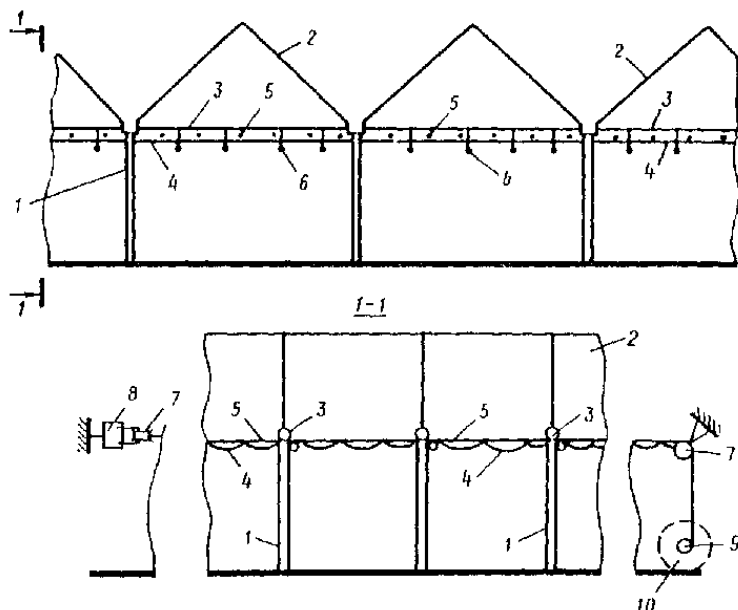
Вариант схемы системы экранирования в многопролетной теплице: 1 – стойка теплицы; 2 – кровля; 3 – затяжка теплицы; 4 – трансформирующиеся шторы; 5 – опорные и приводные тросы; 6 – шпалерные опоры; 7 – опорные блоки; 8 – натяжное устройство; 9 – приводной вал; 10 – реверсивный мотор-редуктор
